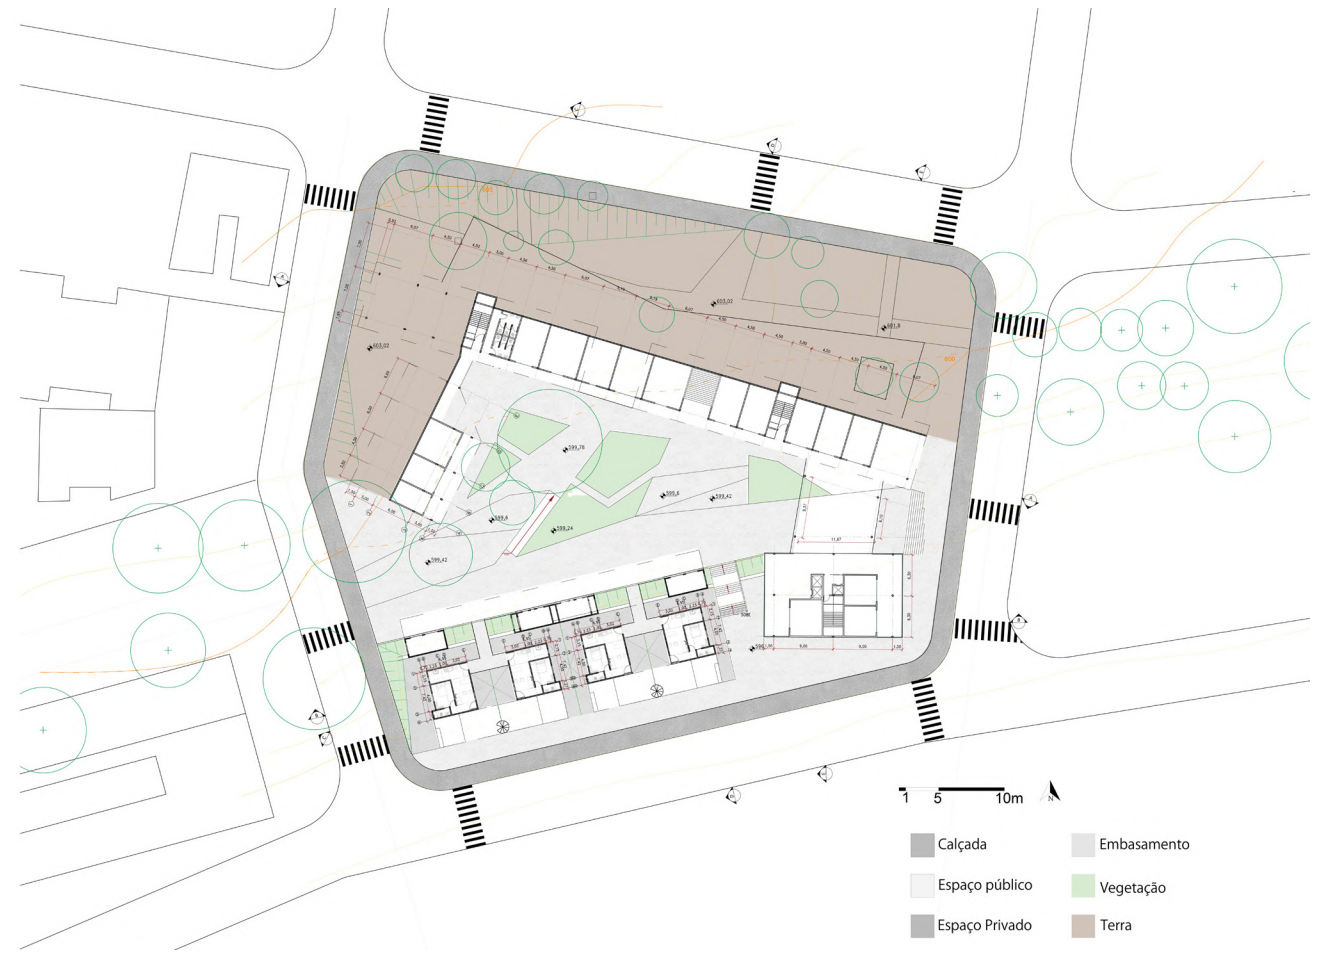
[Planta Cotas 599 e 600. Autor: Autoria da equipe (2022)].
